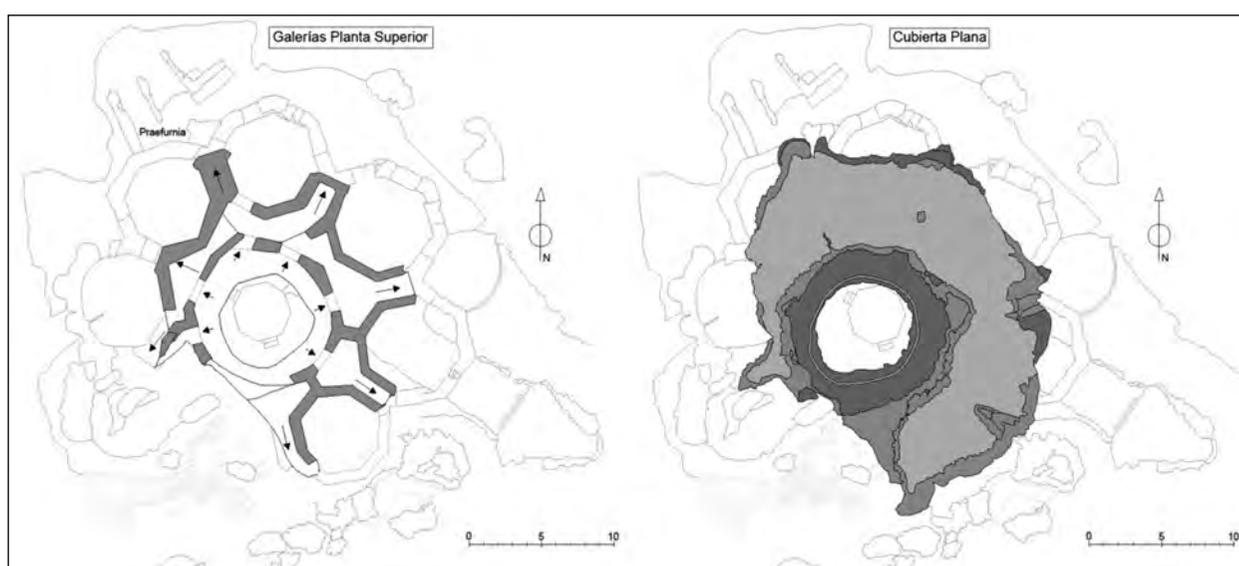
La imagen de la izquierda, las «Galerías Planta Superior», es una adaptación de uno de los planos de CONESA BERNAL (1982). El resto son de realización propia
